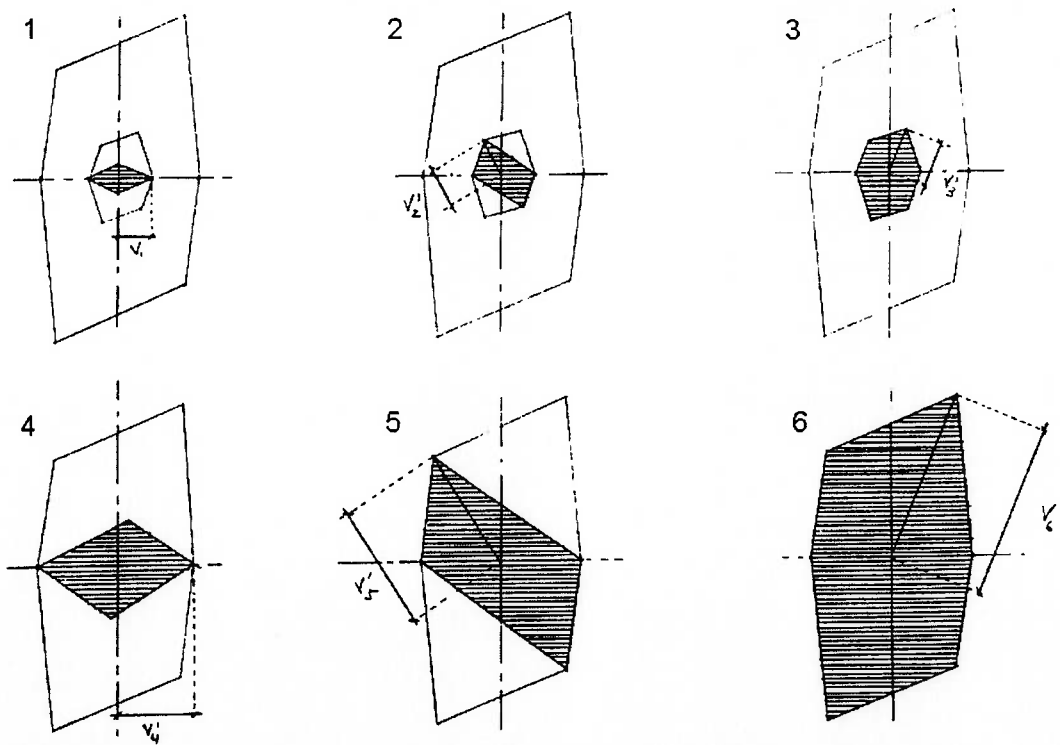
Sequência de detonação do pilar em dupla espiral
